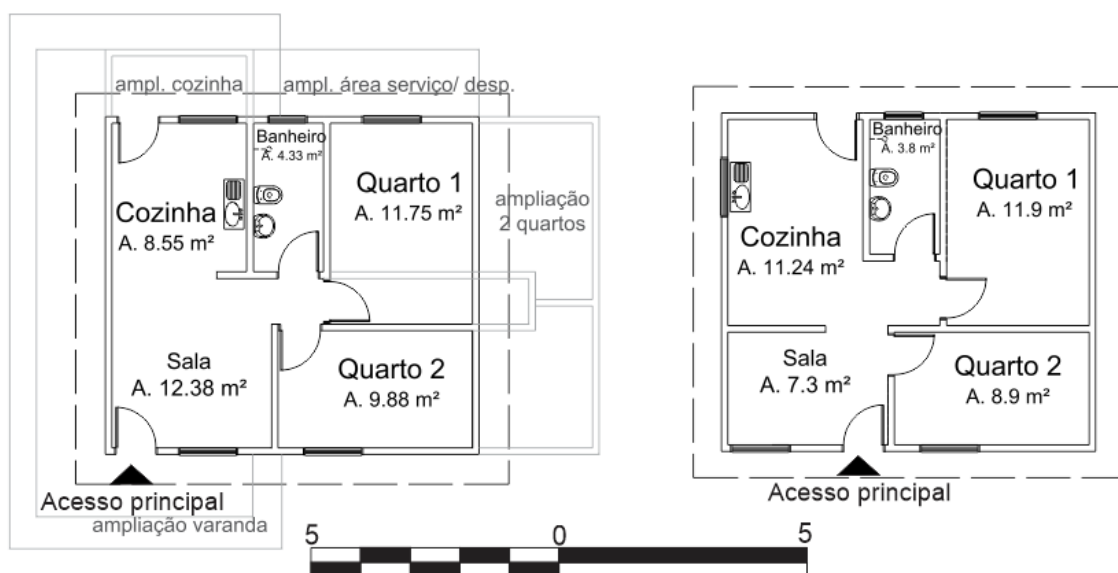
Planta baixa fornecida pela Caixa e a planta baixa da casa construída pelo Seu Pedro, respectivamente, Assentamento Conquista.
